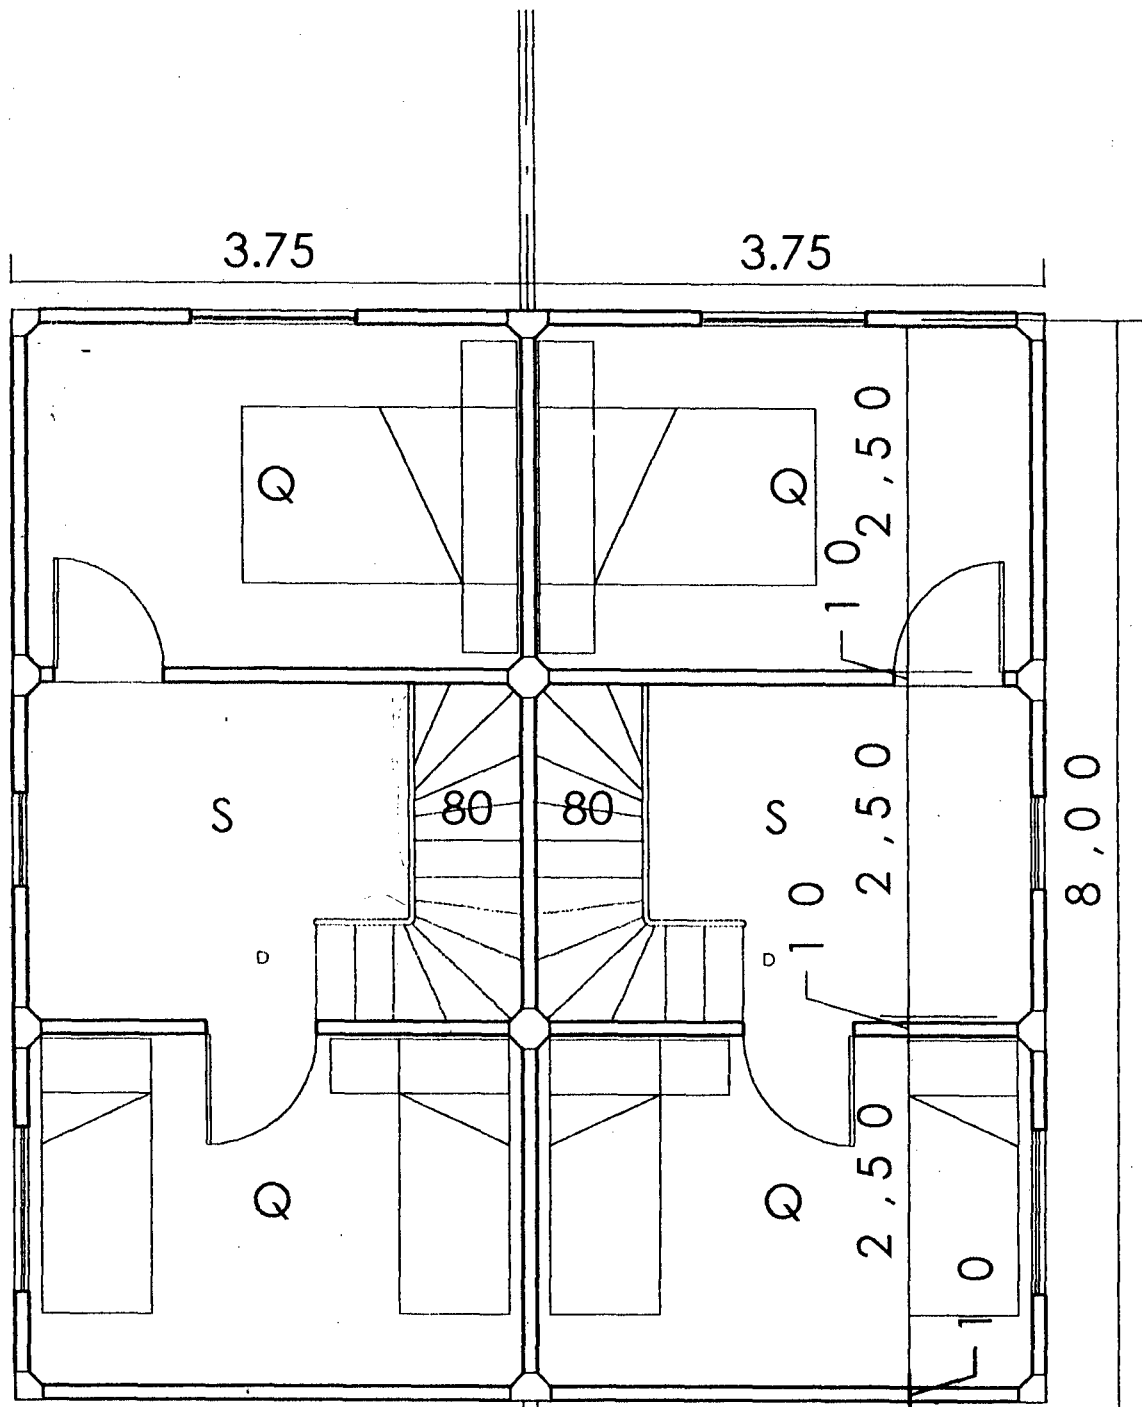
Planta da Residência Geminada: Pavimento Superior.
